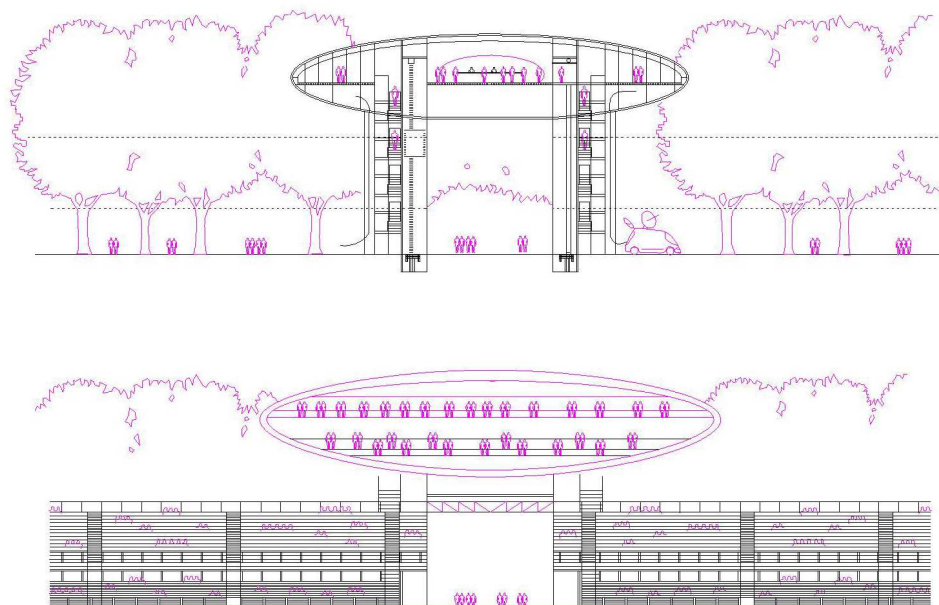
Nat West Media Center al Lord's Cricket Ground, particolare
